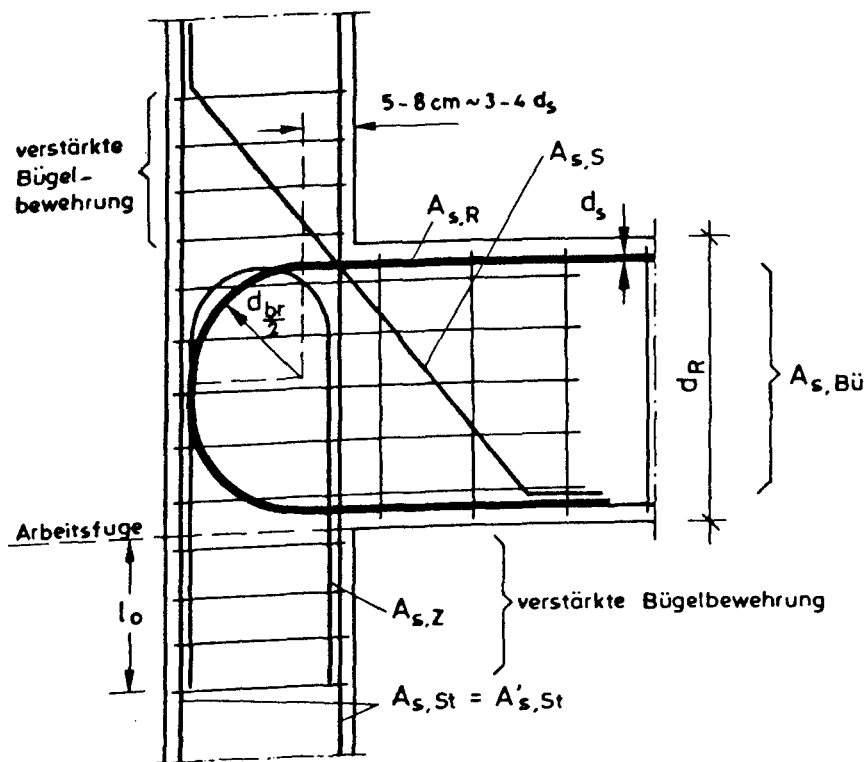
Empfohlene Bewehrungsführung mit Schlaufen
